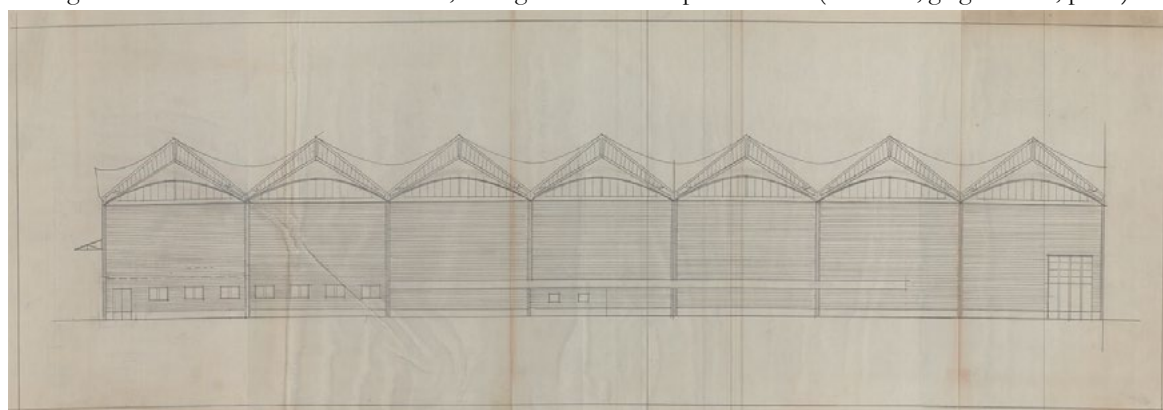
Stabilimento Firsat/Mec, Moncalieri. Prospetto lato nord (Politecnico di Torino, Archivi della Biblioteca "Roberto Gabetti", *fondo Bertone*, dossier 78).
